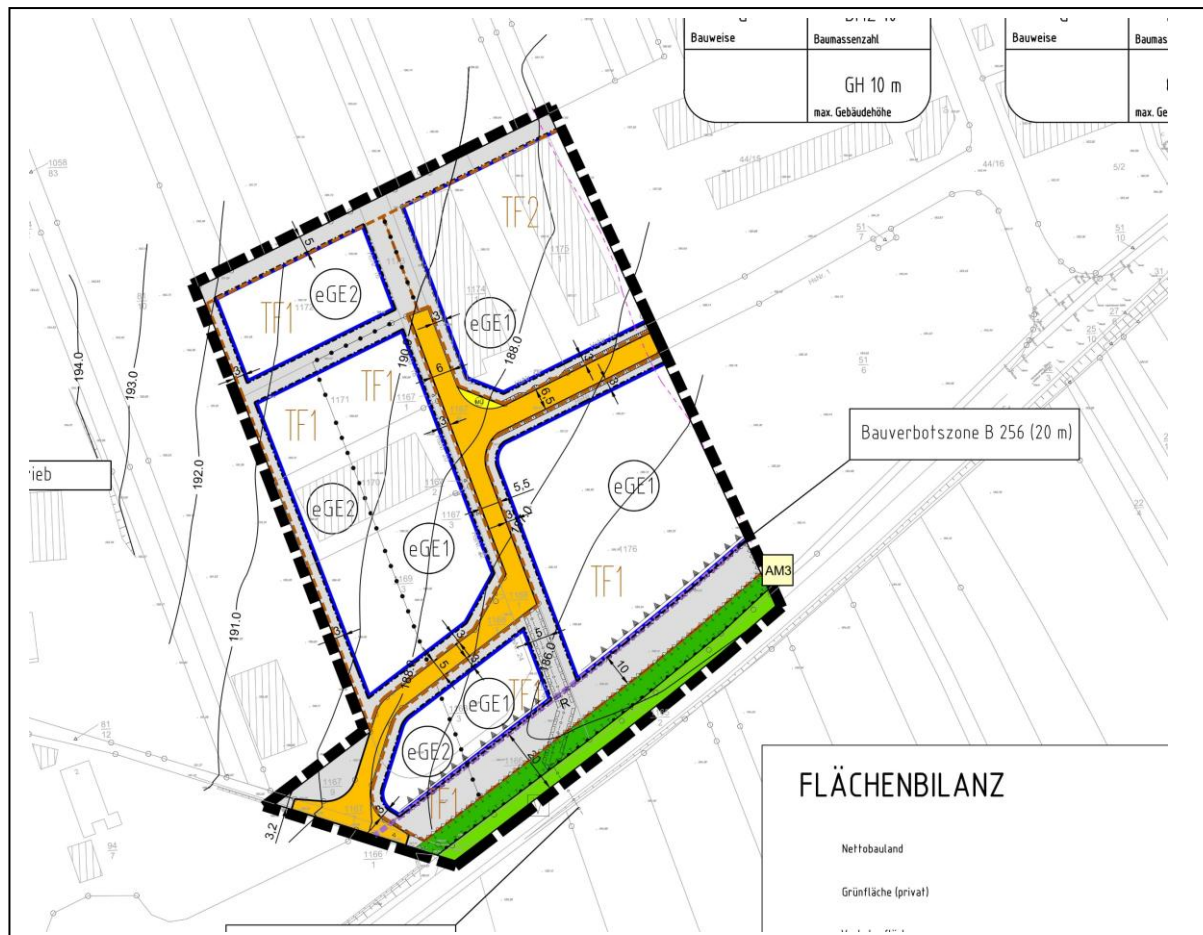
Ausschnitt aus dem B-Plan „Gewerbegebiet der B 256 II“ – 1. Änderung
